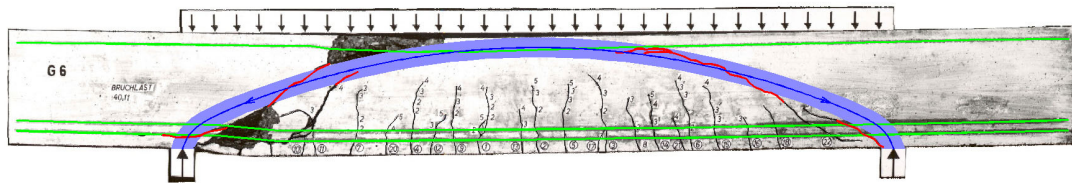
Balken G 6 mit überlagerter Druckparabel und zugehörigen Rissen
